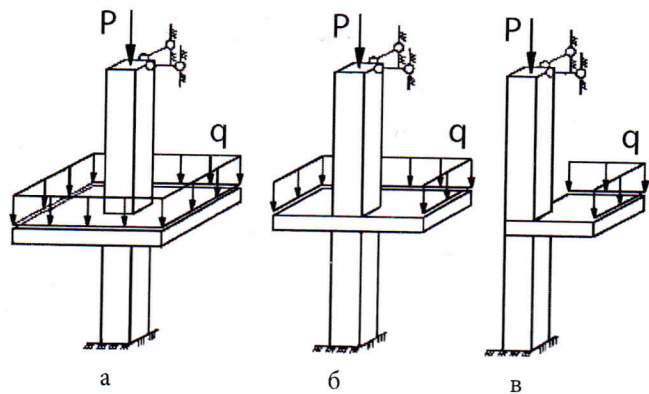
Расчетные схемы моделей узлов перекрытия с колоннами:
